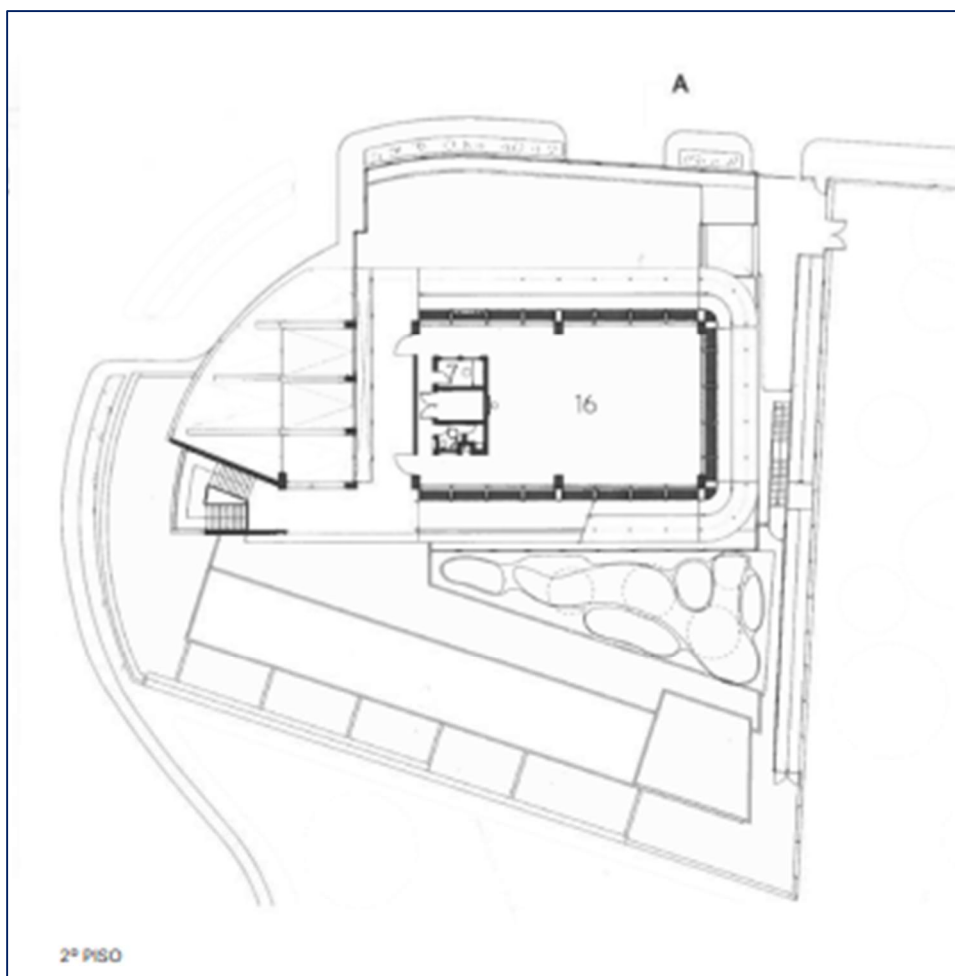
Plantas baixa térreo da escola FAVA, sem escala.
